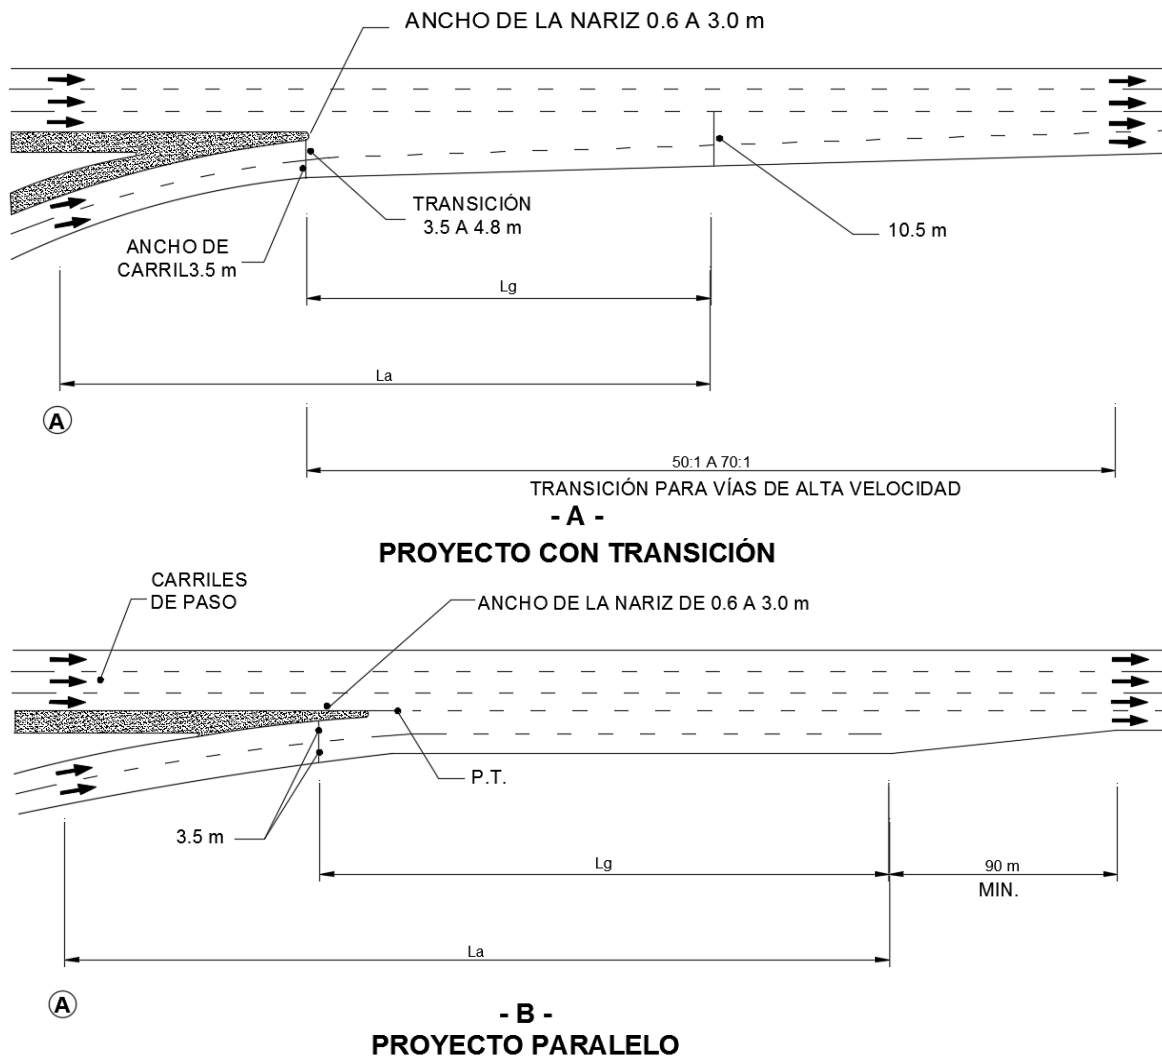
Rampas típicas de entrada de dos carriles
